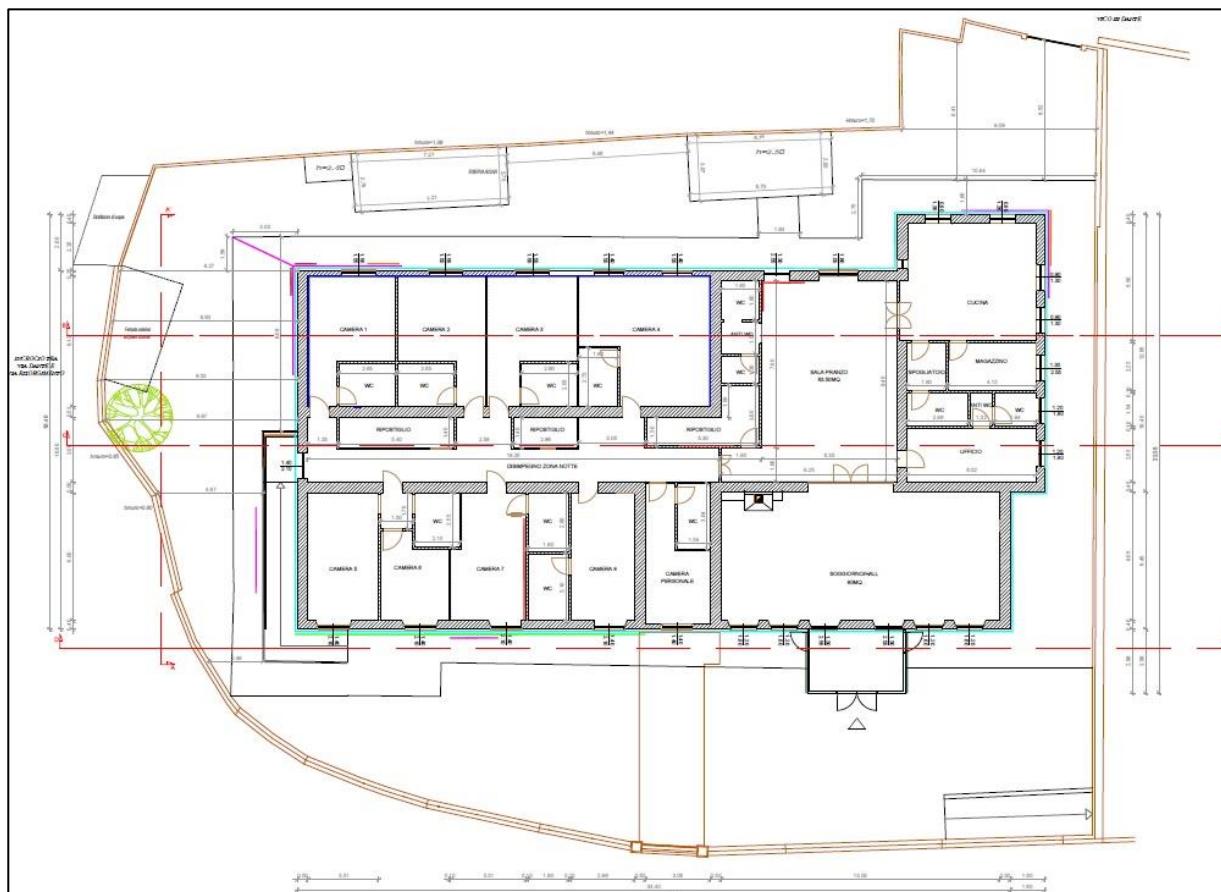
Planimetria stato di fatto con indicato le alterazioni e degradi
